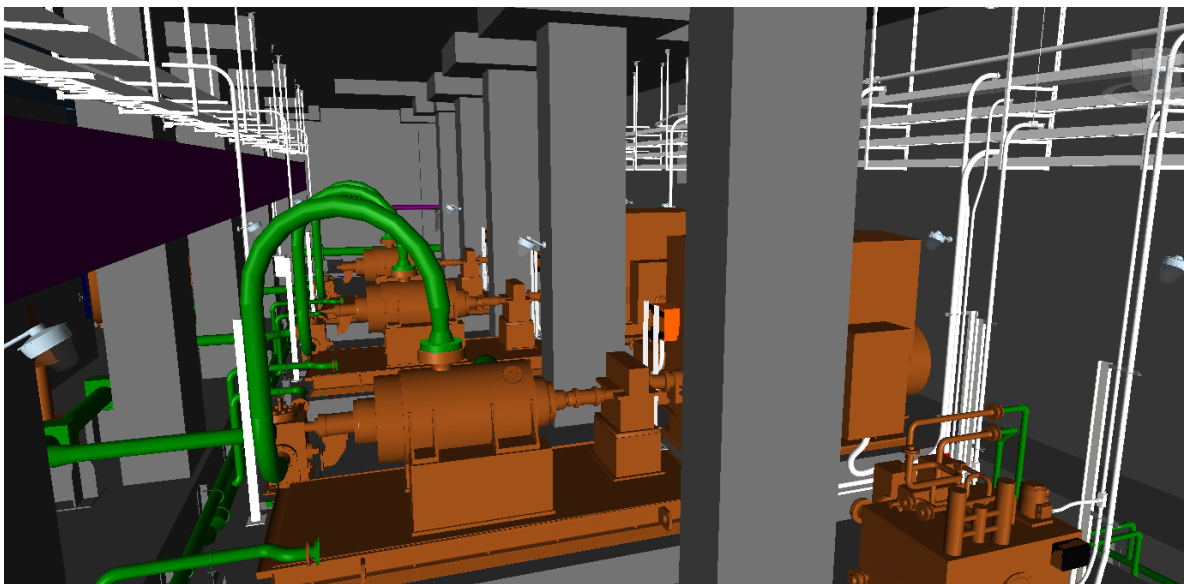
Casa de Bombas - Projeto Industrial. Pilares e Vigas em concreto armado modeladas no Revit e Calculadas no Robot. Modelo compatibilizado no Navisworks mostrando as redes de tubulações e equipamentos mecânicos
